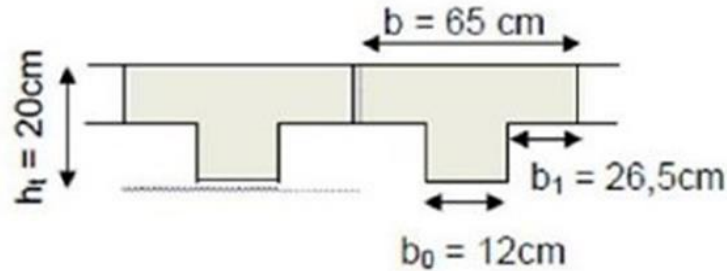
Section de la poutrelle après coulage de la dalle de compression.
